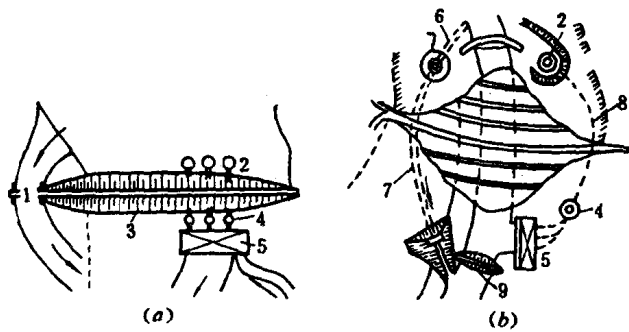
坝后式水电站平面布置示意图 (当地材料坝)
